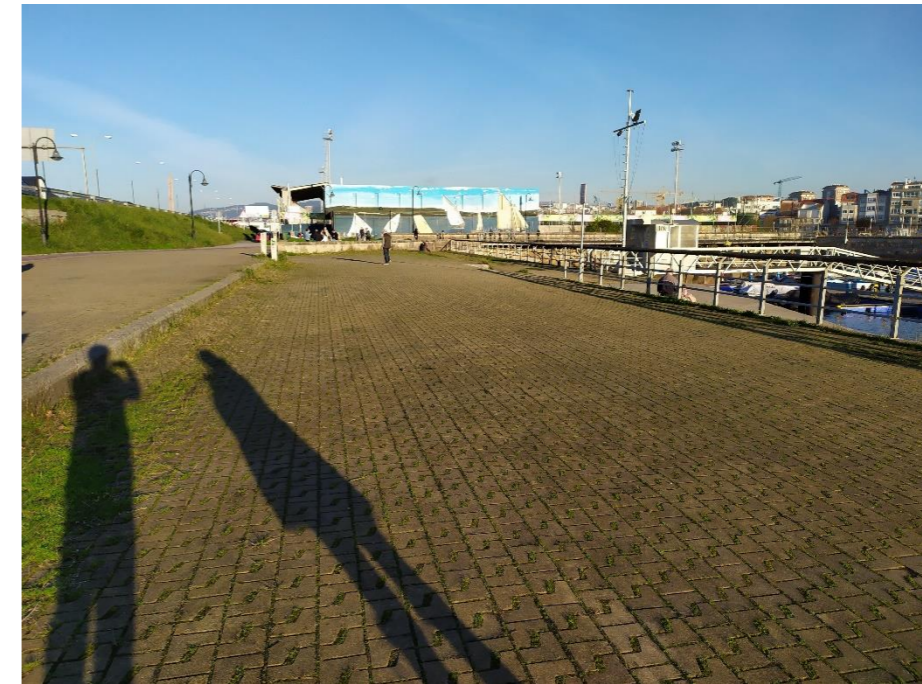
Paseo peatonal en la explanada de pavimento de piezas de hormigón
